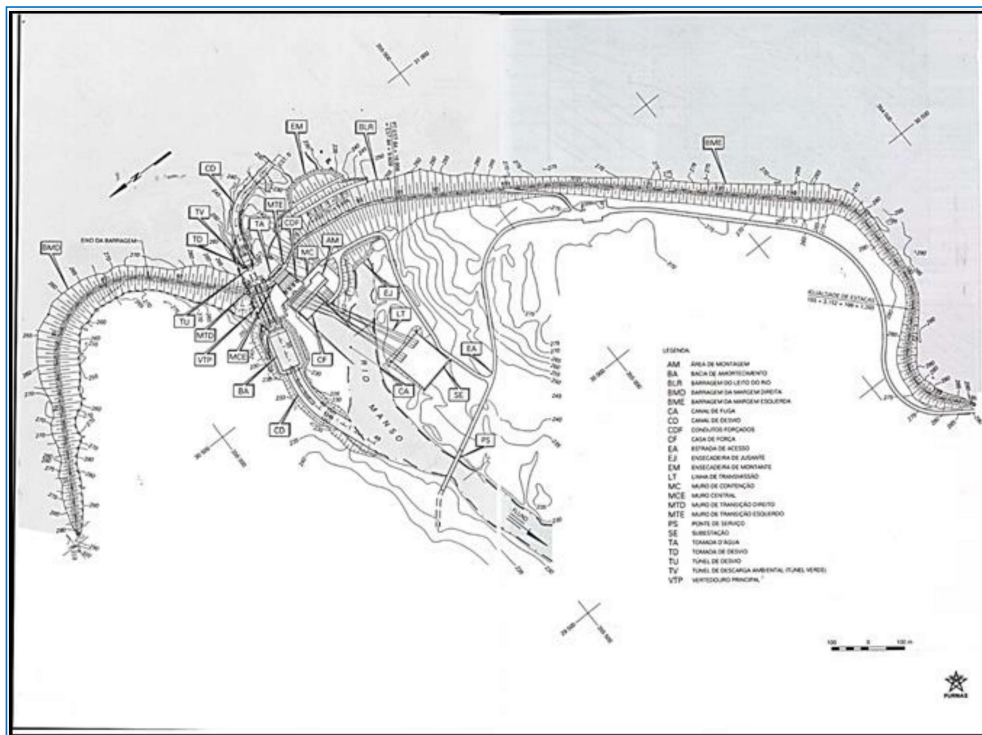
Arranjo das estruturas componentes do empreendimento por completo.
